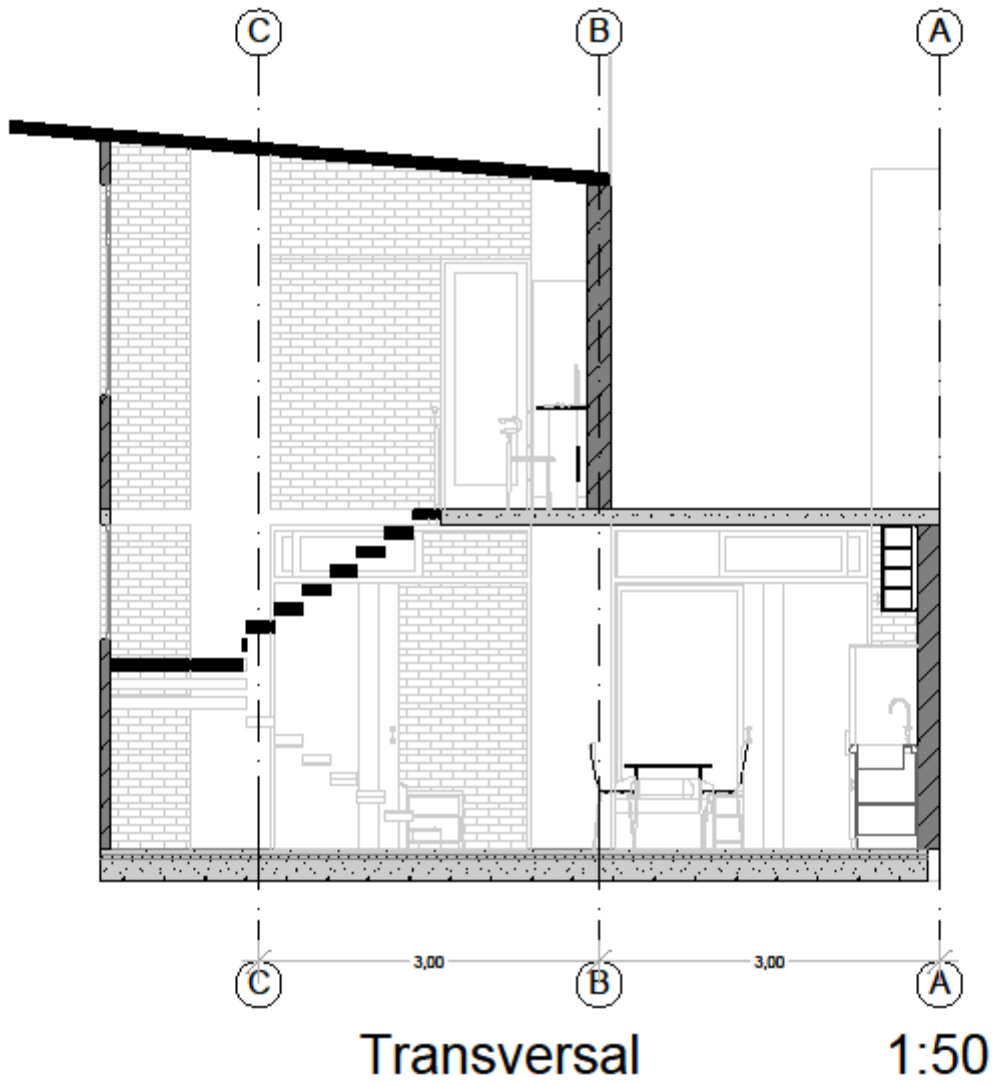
Tipo B. Corte C-5. Esc.: 1:50
